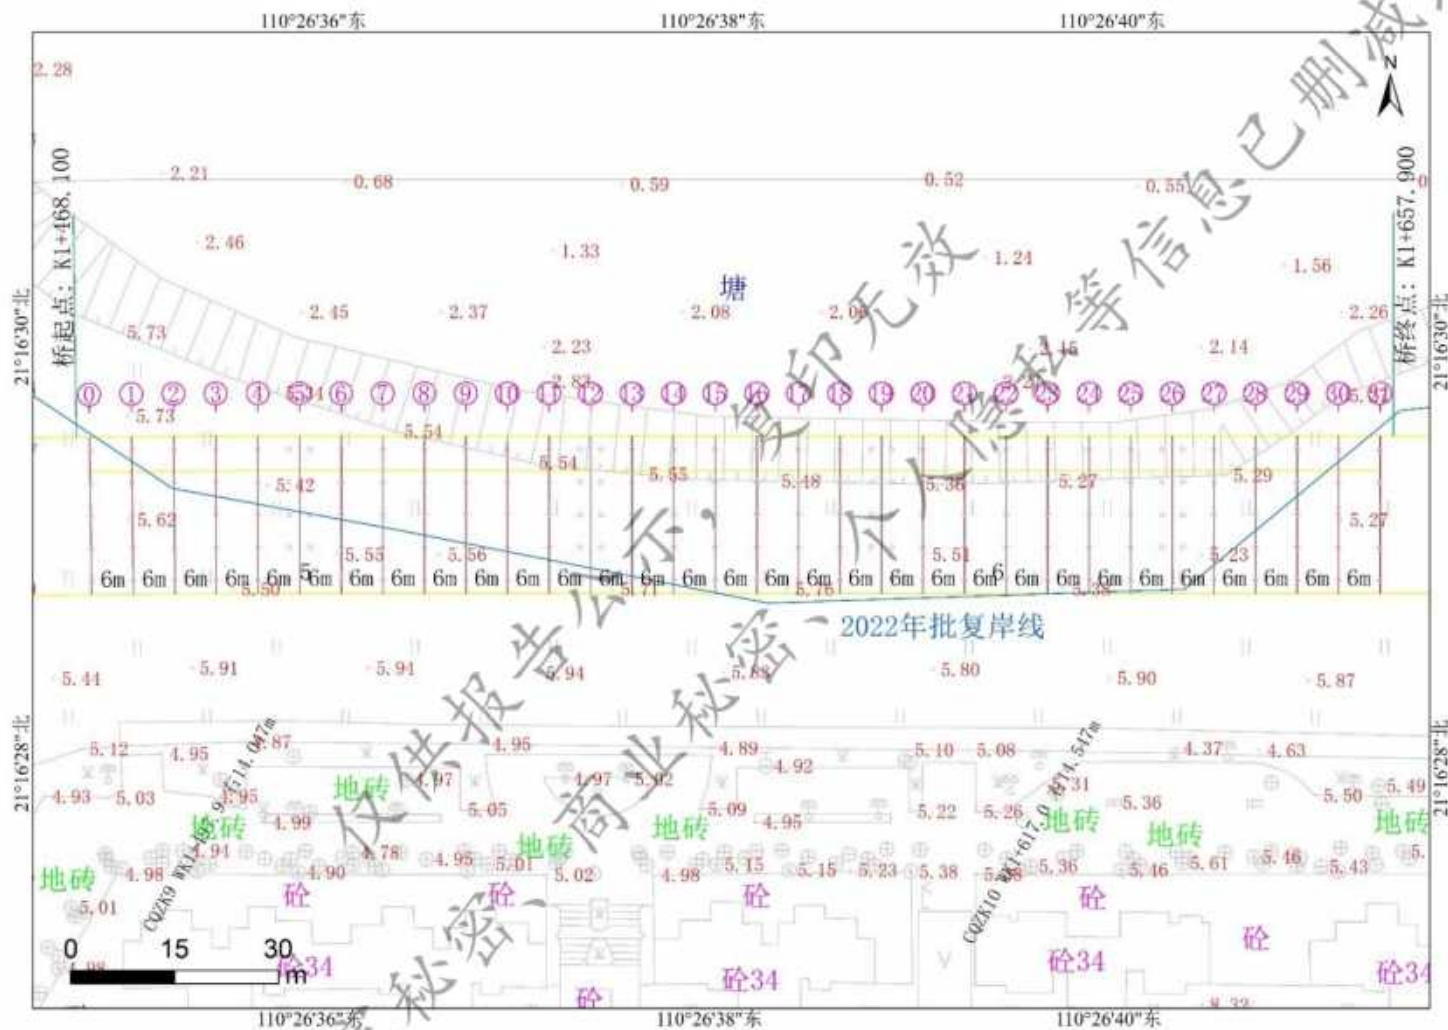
海旺路 2 号桥总平面布置图 (2)
